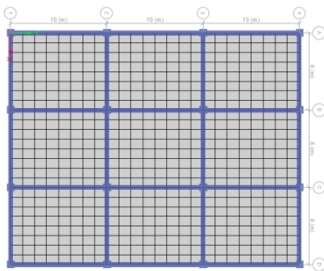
Planta de modelo de 40 niveles orientado en Eje Y
